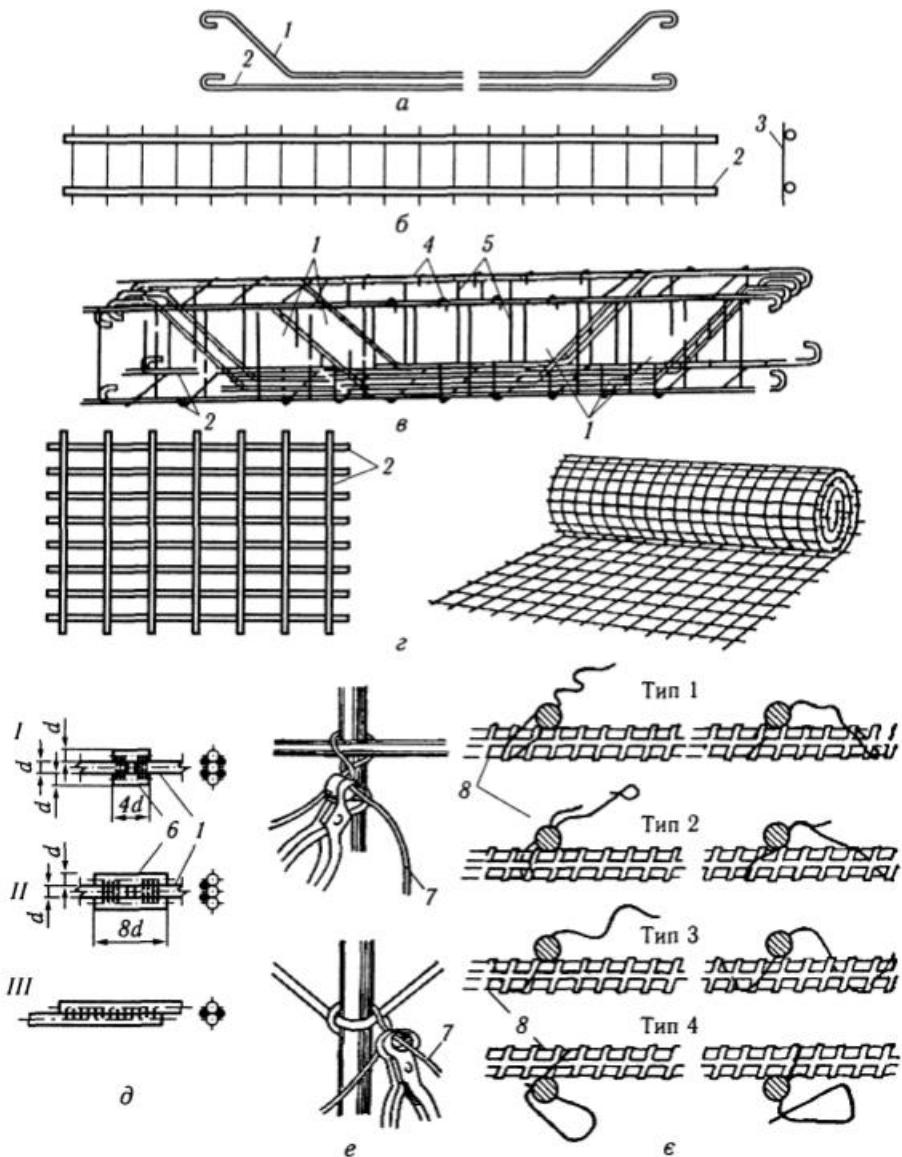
Види арматури та типи з'єднань арматурних стрижнів:
